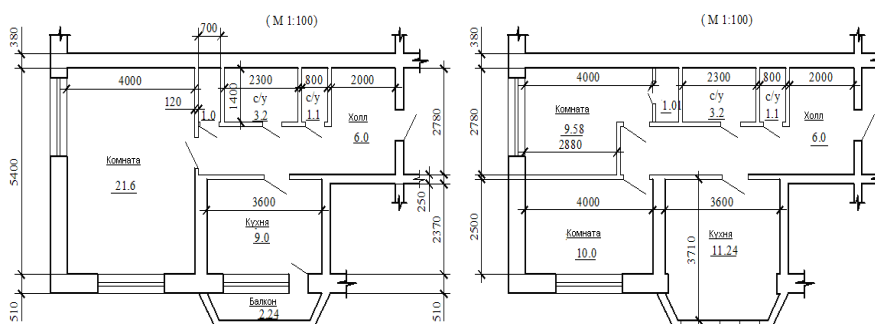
Третий вариант перепланировки однокомнатной квартиры
